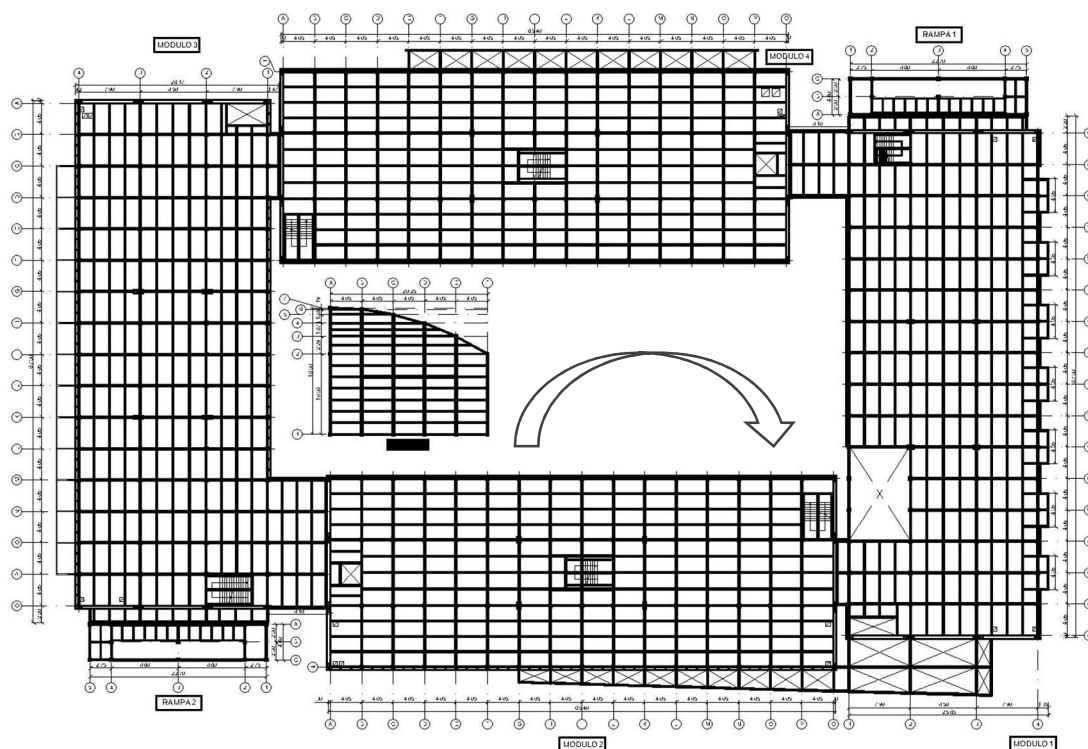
Vista Planta conjunto Estructura metálica Hospital de Guanta
